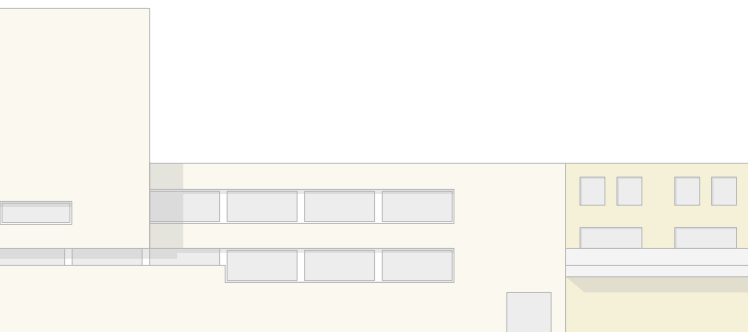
Aanzicht frontaal vanaf plein
